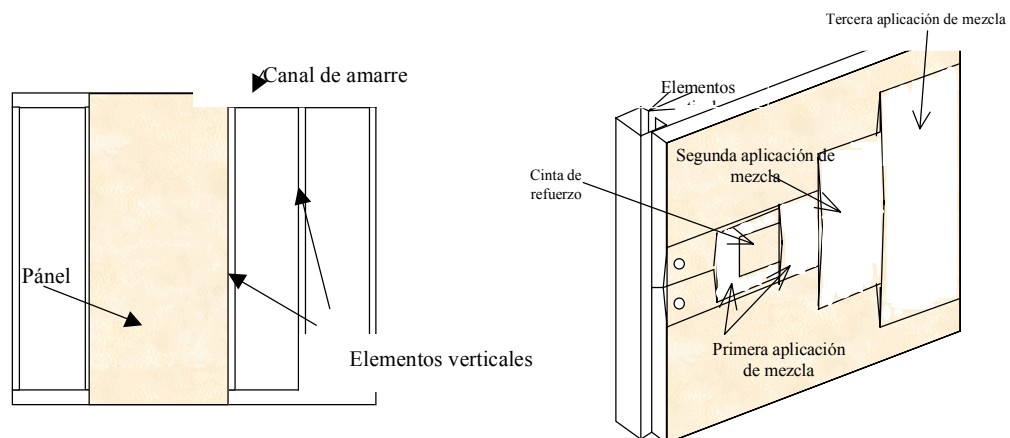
Ubicación de paneles de Drywall y detalle de acabados, cinta de refuerzo.
